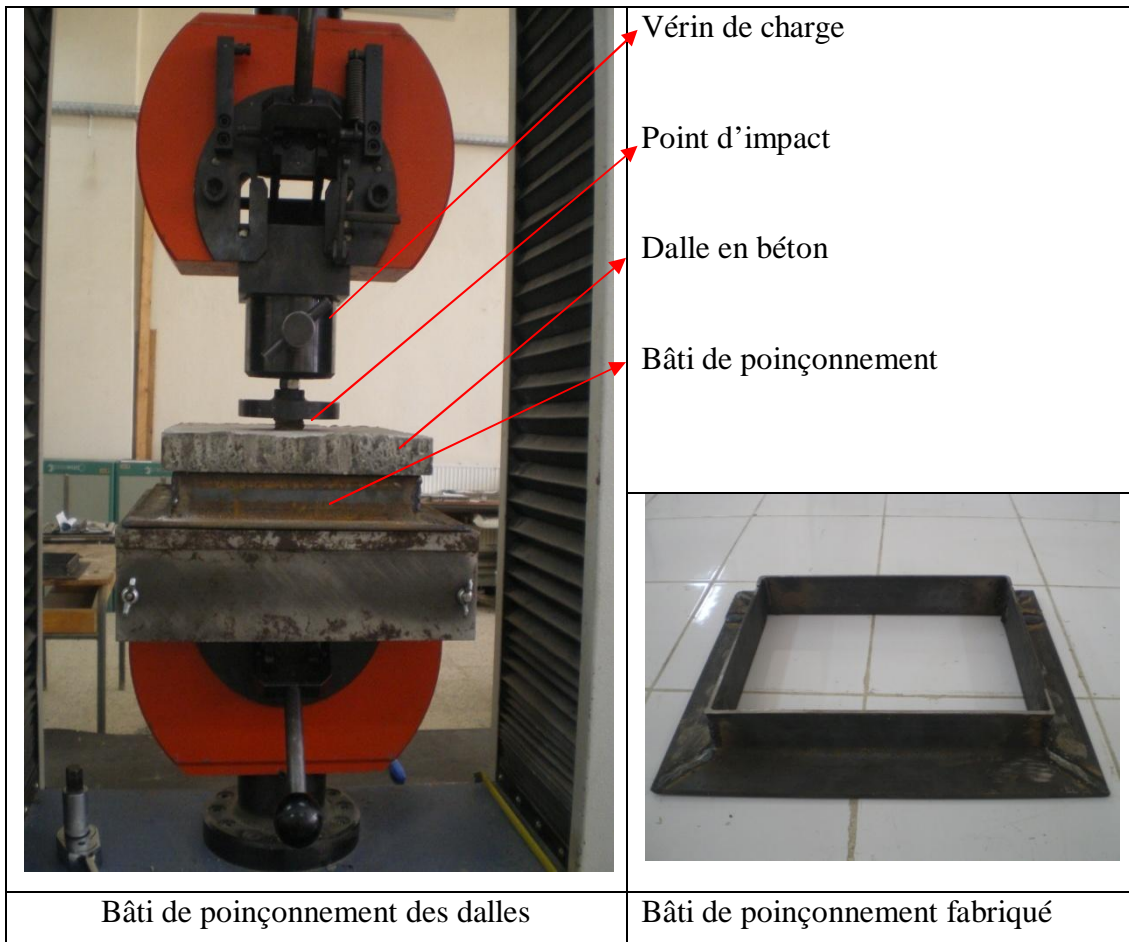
Mise en point de l'essai de poinçonnement
